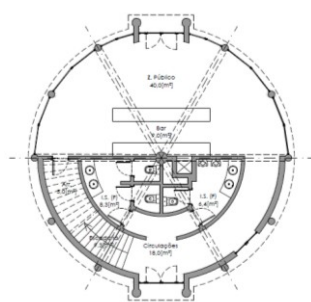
ERB [EXISTENTE], PLANTA PISO 0 [VLÓIO, 2011].
